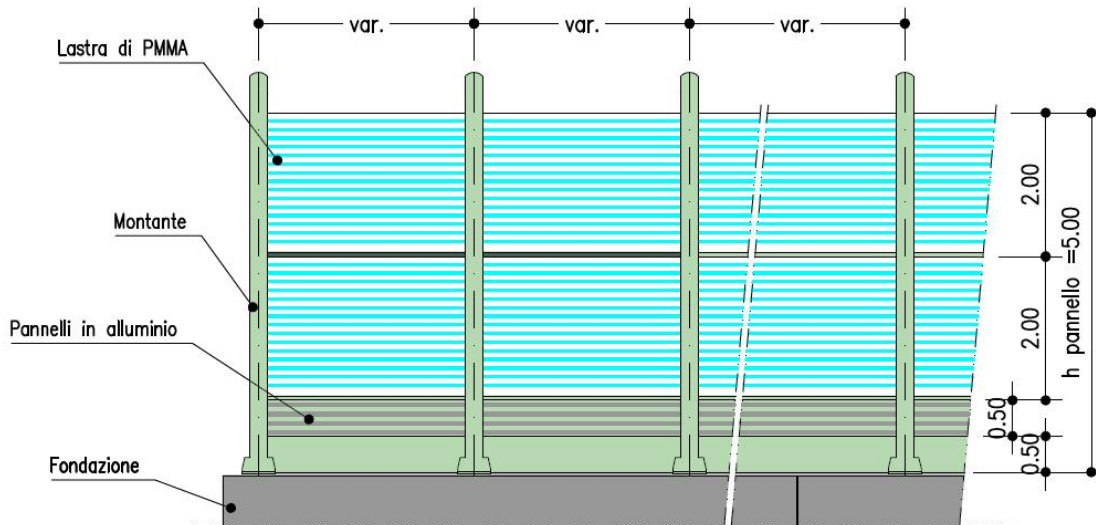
Barriera TRASPARENTE H=5m – Prospetto lato ricettore
